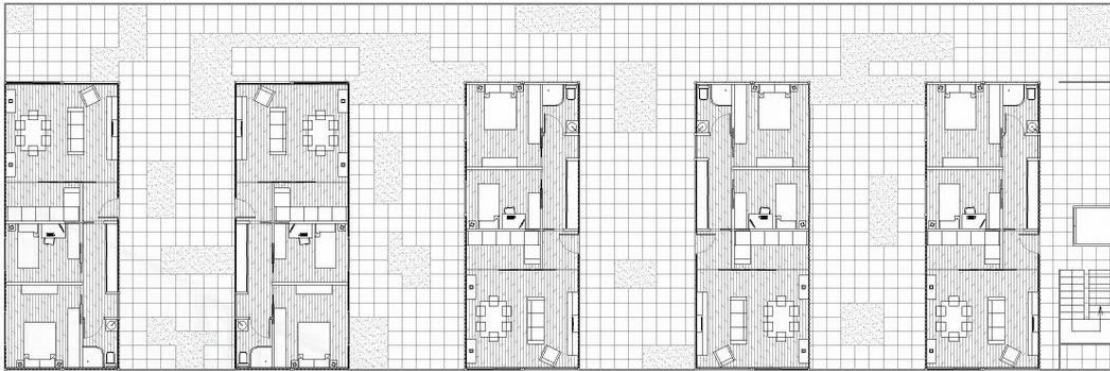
Plantas tipo, Containers en Portugaete, Holcim Edición.
